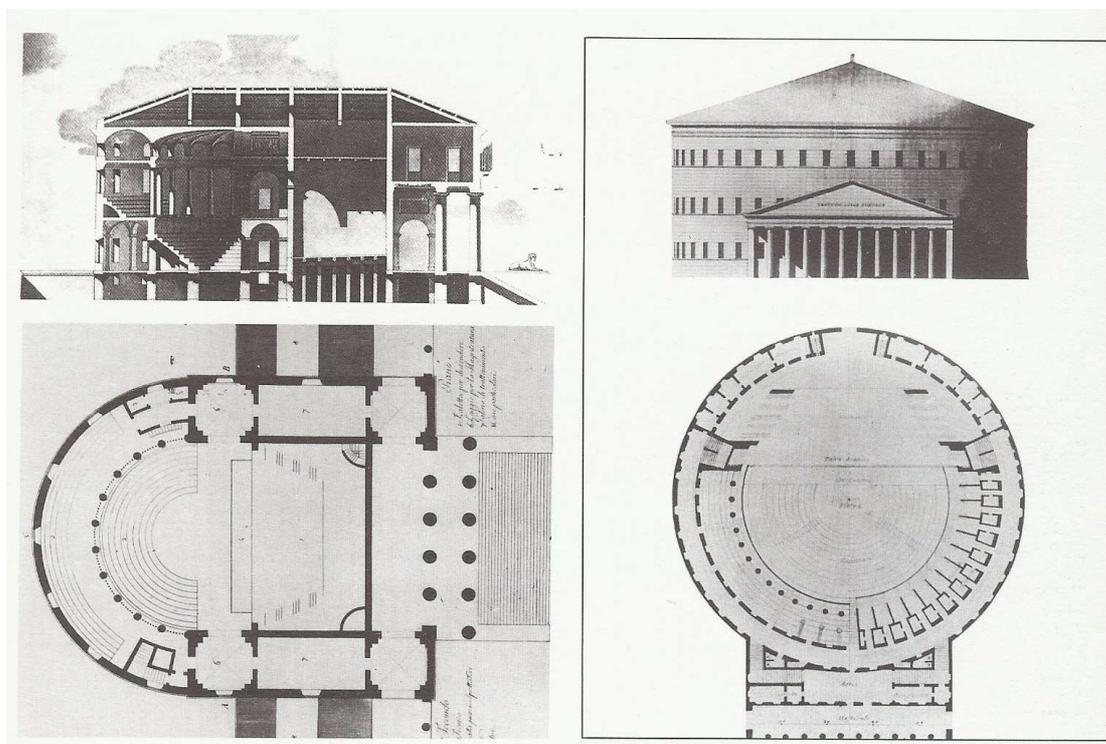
, a sinistra: Giovanni Antonio Antolini, *Teatro nel Progetto per il Foro Bonaparte*, Milano, 1801: sezione longitudinale; pianta. Fig. a destra: Giuseppe Pistocchi, *Progetto di teatro*, Milano (?) 1810: Prospetto; pianta.
